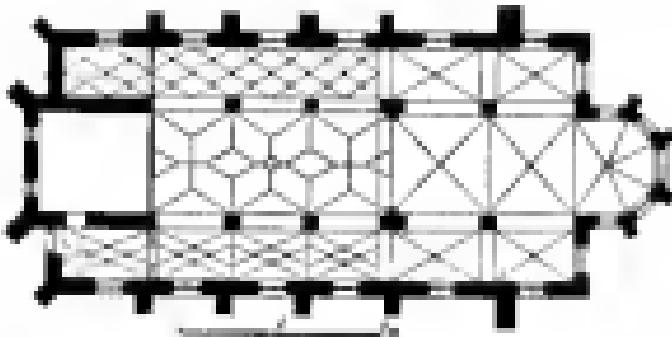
Fig. II. Grundriss: Umriss der evangelischen Kirche
